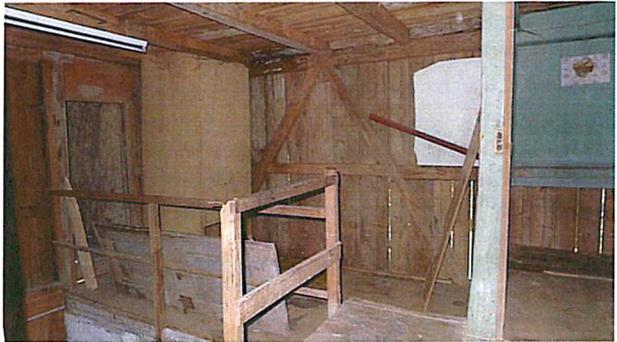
Anbau an der östlichen Trauffassade hinter der Küche. Blick nach Nordosten. Im Vordergrund das Treppengeländer der Treppe vom Hochparterre zum aussenliegenden Kellerzugang an der östlichen Trauffassade.
